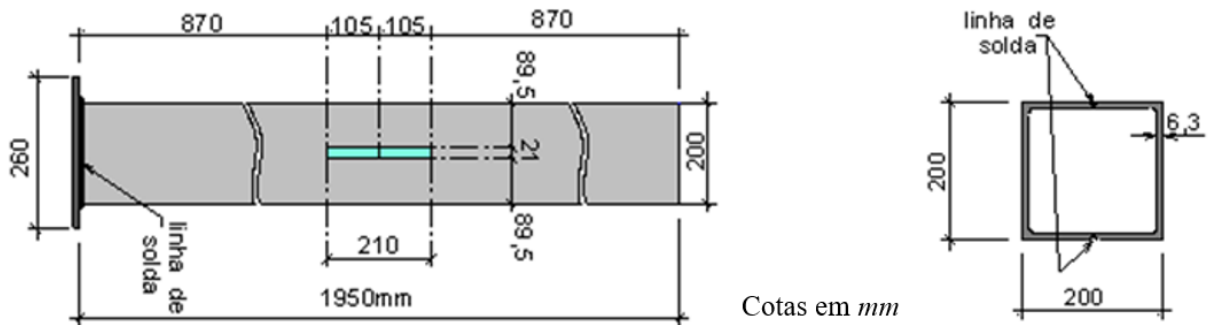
Detalhes do perfil de aço do pilar misto (DE NARDIN, 2007)
